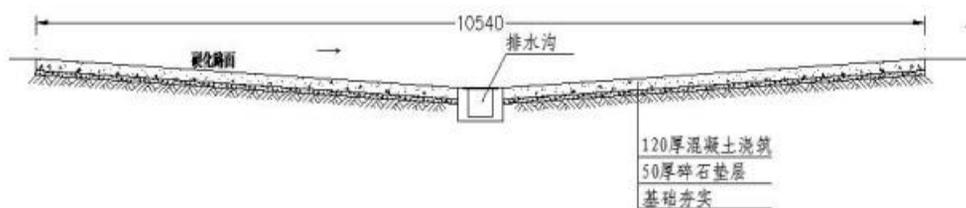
车辆清洗平台典型设计图（单位：mm）
